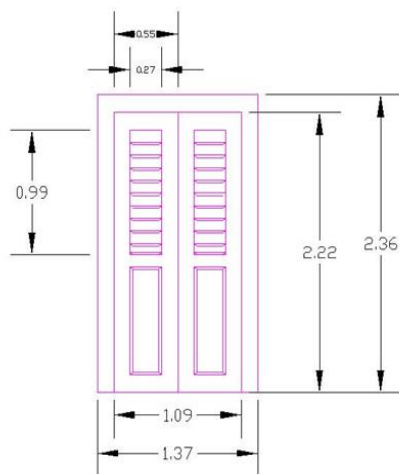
(b) Detail Lubang angin Rumah Bastion
